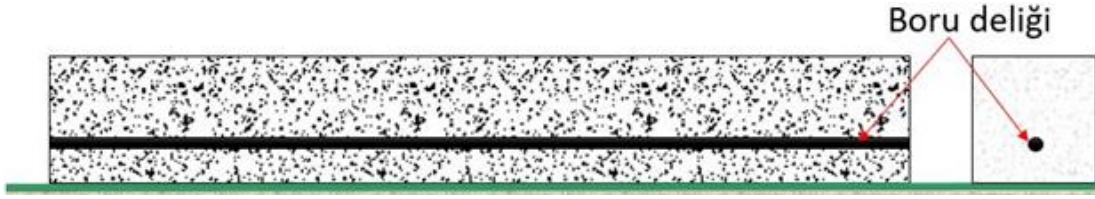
Öngerilme yönteminde beton dökülmesi
